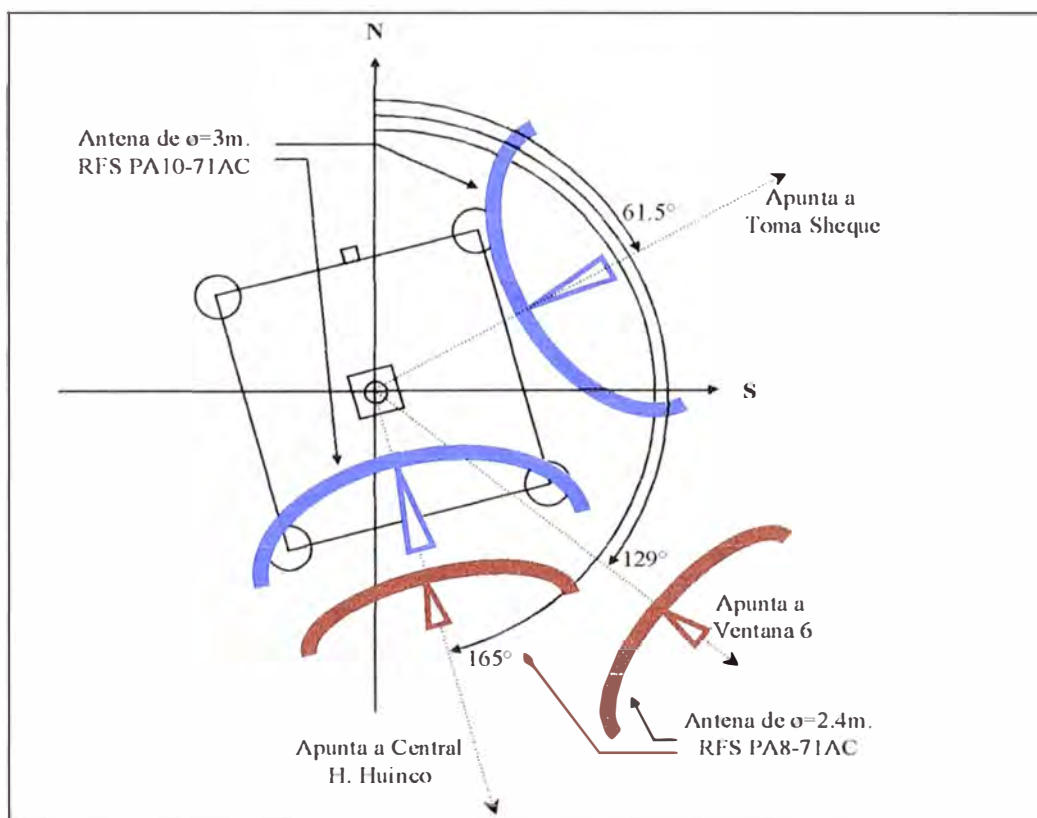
Vista de Planta de la Torre – Cerro Malca
